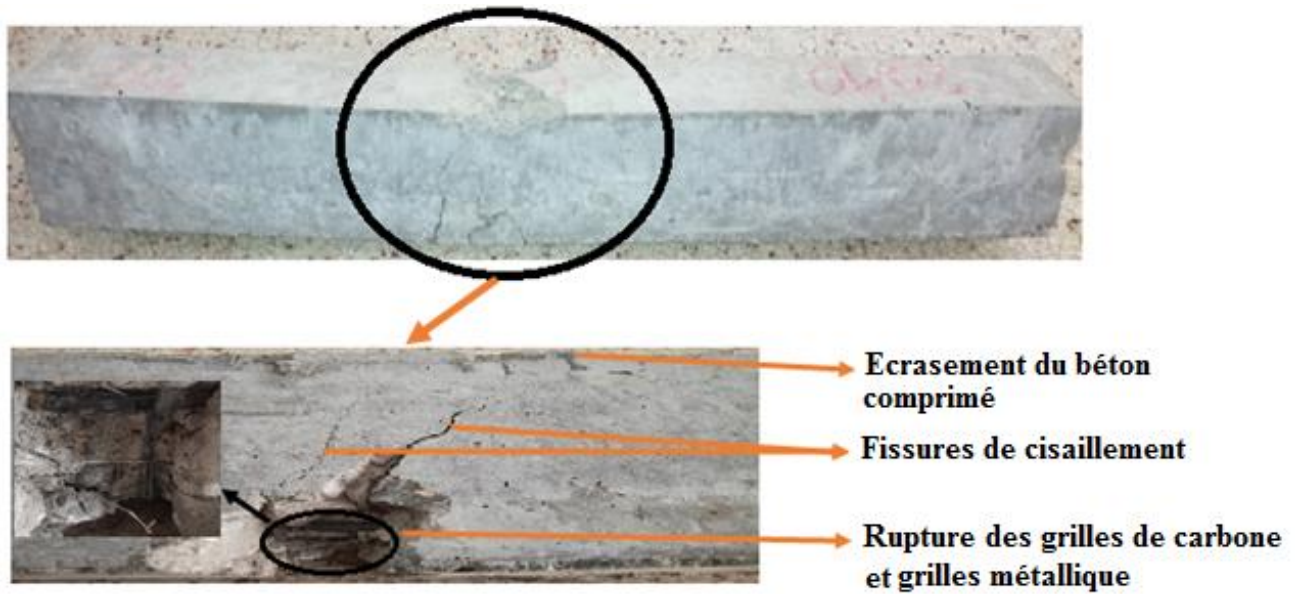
Mode de rupture des poutres renforcées du groupe 04 (poutre CMIEL (04)).
